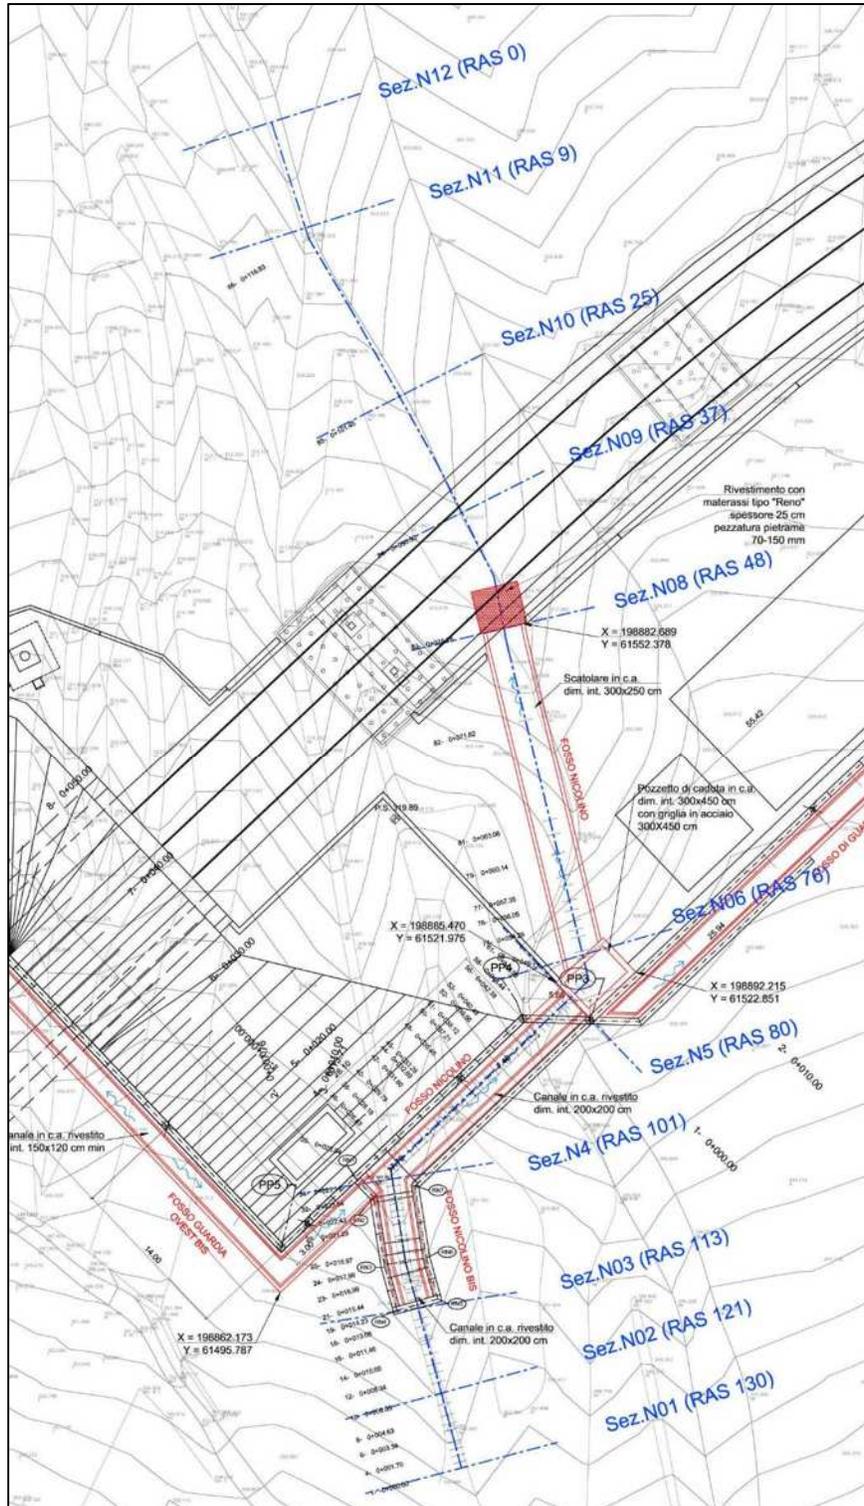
Fosso Nicolino – Planimetria e indicazione sezioni RAS
